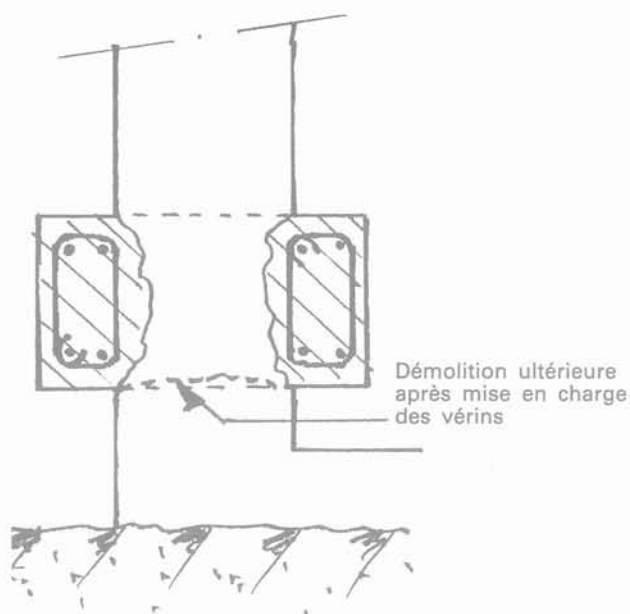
Prises de gros murs en maçonnerie par poutraison S.A. en sandwich.
